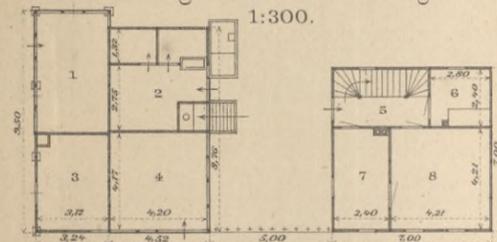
u. 6. Grundrisse des Erdgeschosses.
